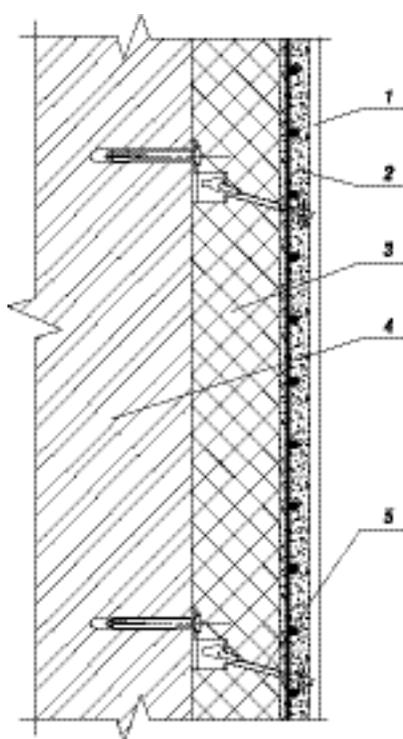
Конструкция тяжелой штукатурной системы «Радекс»: 1 – защитно-отделочный слой; 2 – армирующий слой, состоящий из модифицированной штукатурки, металлической проволочной сетки; 3 – теплоизоляционный слой; 4 – стена здания; 5 – анкерные устройства
